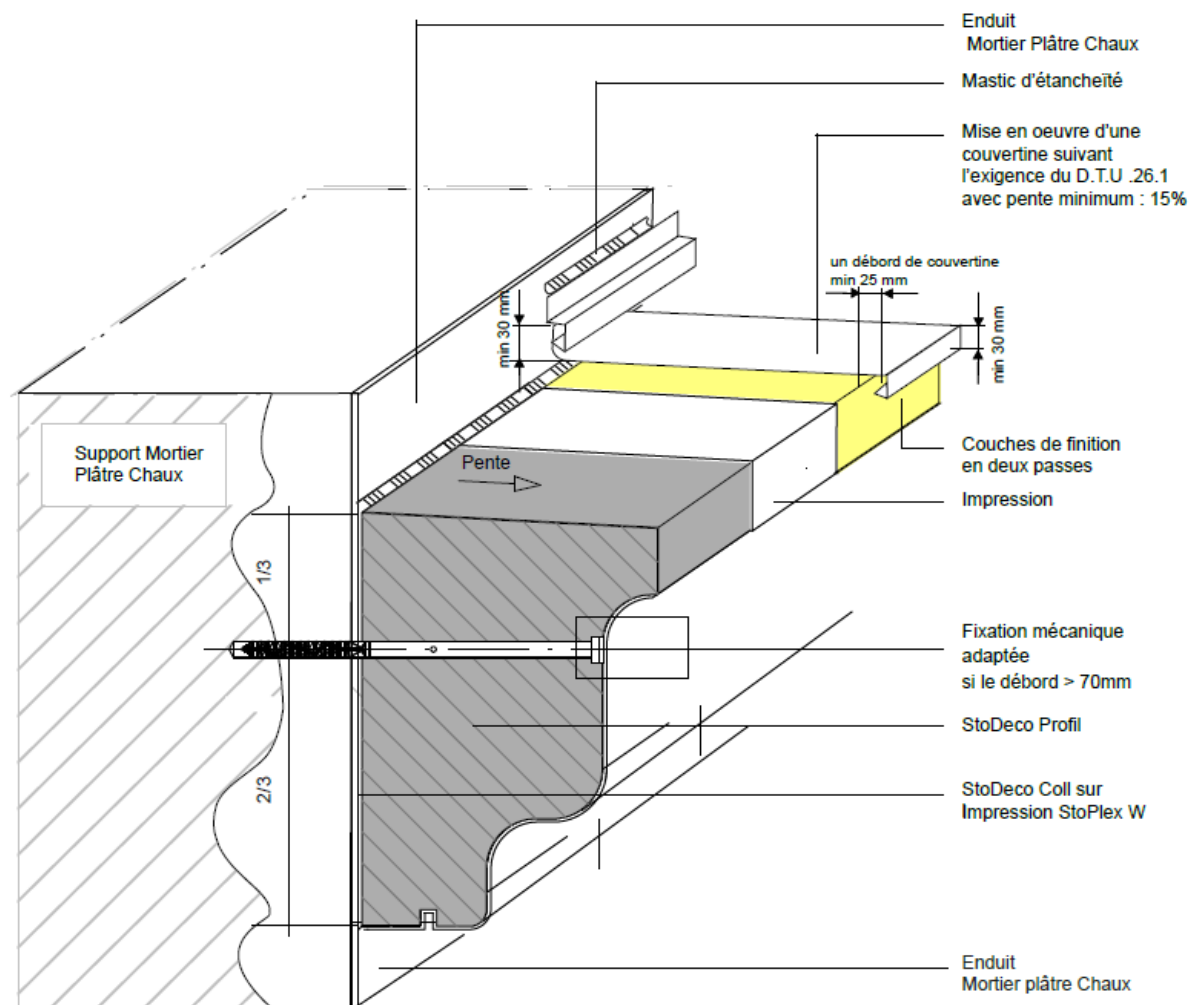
Pose d'un profilé StoDeco Profil sur Enduit Mortier Plâtre Chaux
